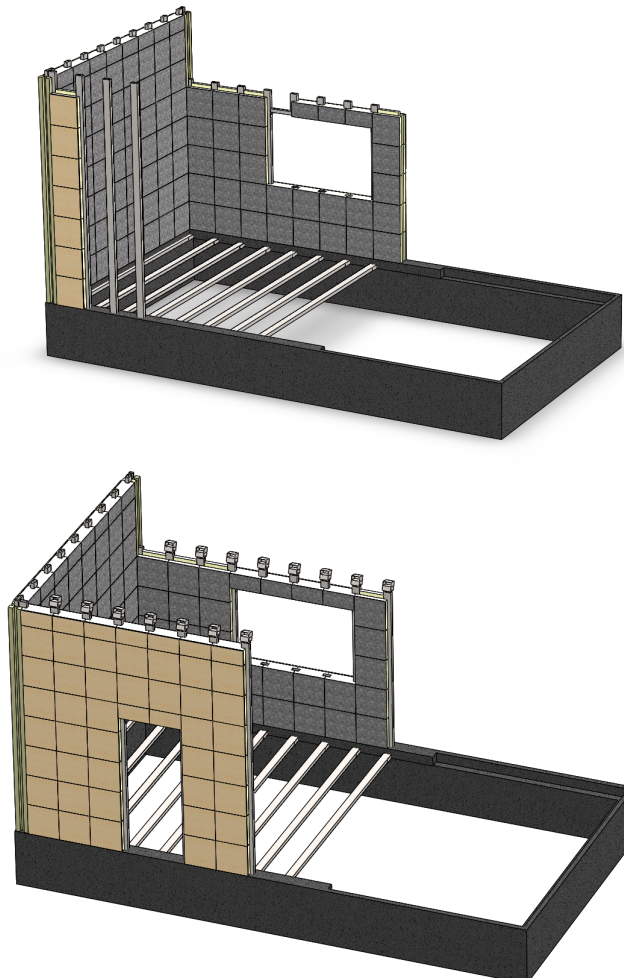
Montagem das paredes, aberturas e encaixes.
